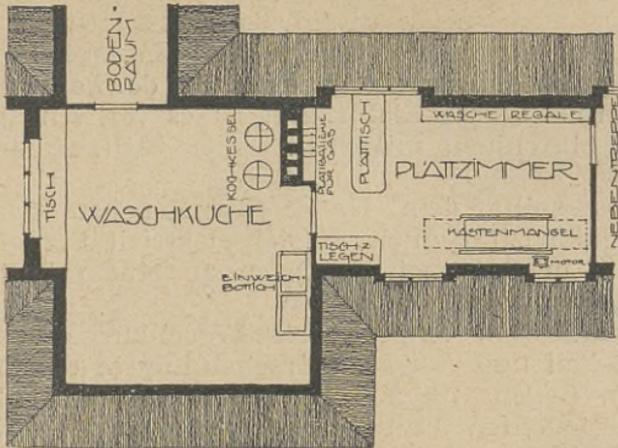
Waschküche und Plättstube für Handbetrieb, im Dachgeschoß eines größeren Hauses
